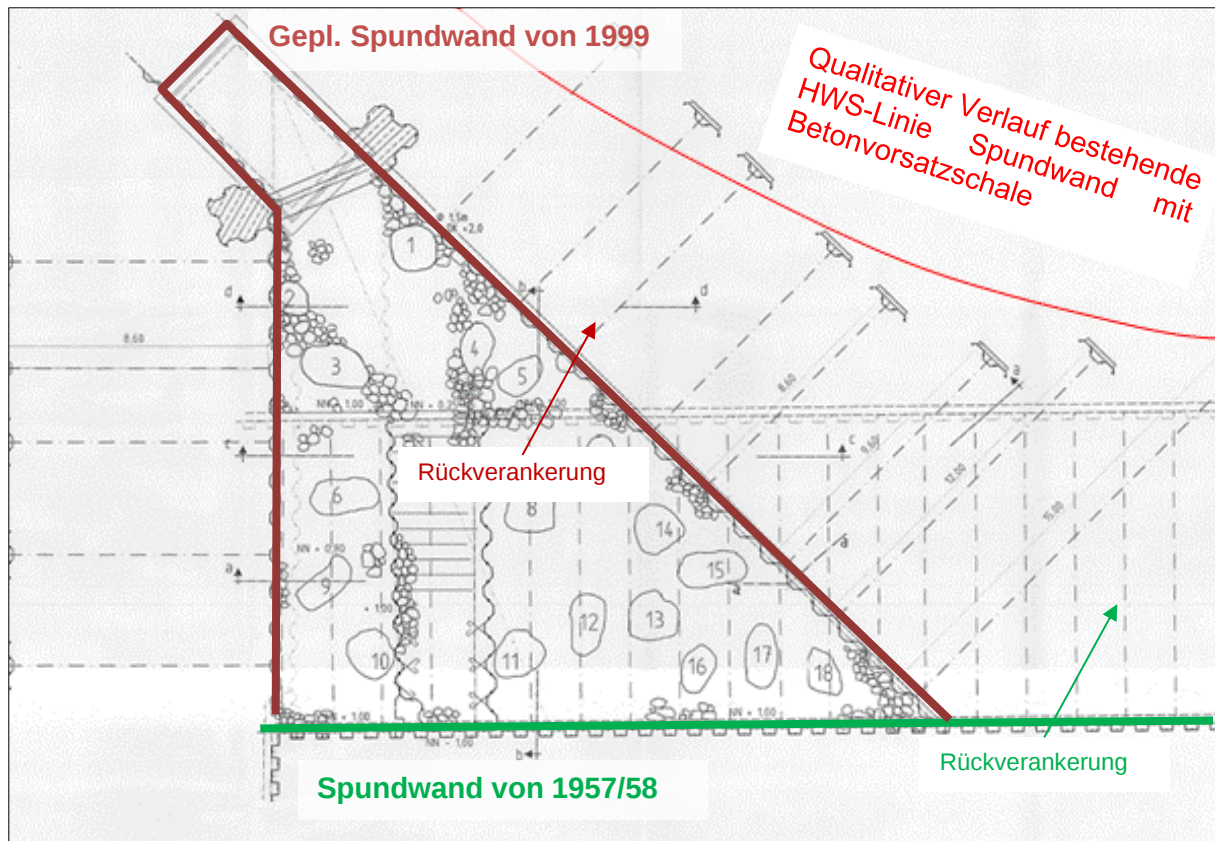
Teilabschnitt I – Umbau des Hafenrandes im Bereich der Auemündung (Ausschnitt und Ergänzungen aus Plan Nr. 84-05-02a; STAVE, 1999)
